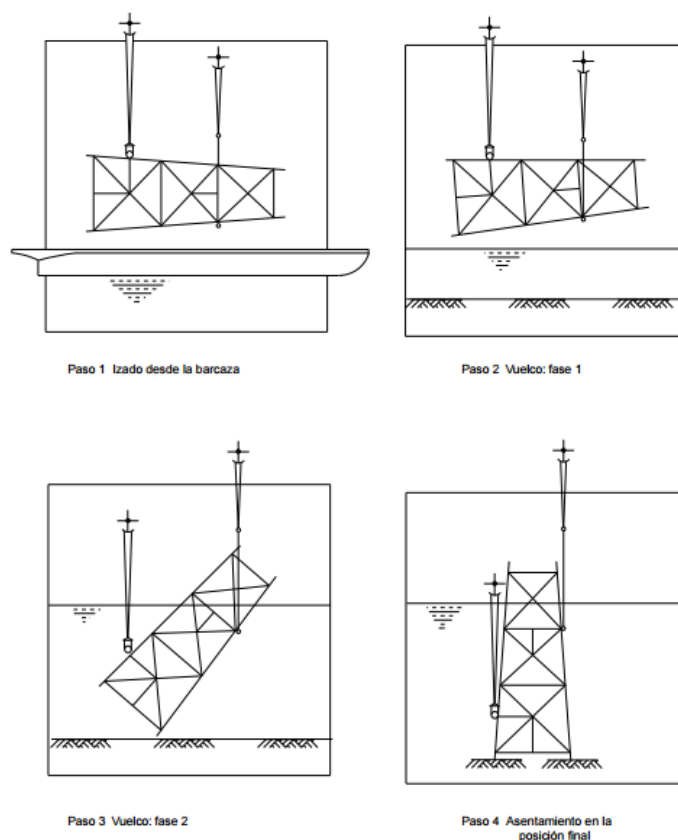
Instalación de la jacket por levantamiento. Fuente: Instituto Técnico de la Estructura en Acero
